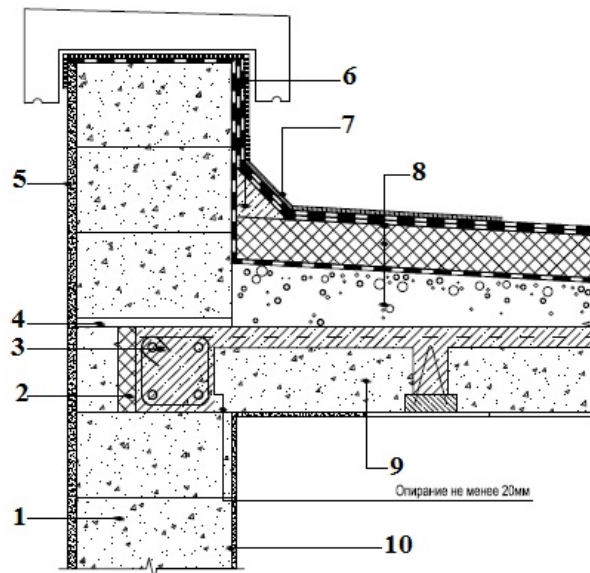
Узел сопряжения стены из газобетонных блоков с совмещенной кровлей и парапетом: 1 — блоки YTONG; 2 — минеральная вата; 3 — железобетонный пояс; 4 — шов из цементного раствора; 5 — наружная отделка; 6 — бортик из цементно-песчаного раствора; 7 — дополнительный слой гидроизоляции; 8 — кровельная конструкция; 9 — сборно-монолитное перекрытие; 10 — внутренняя отделка
